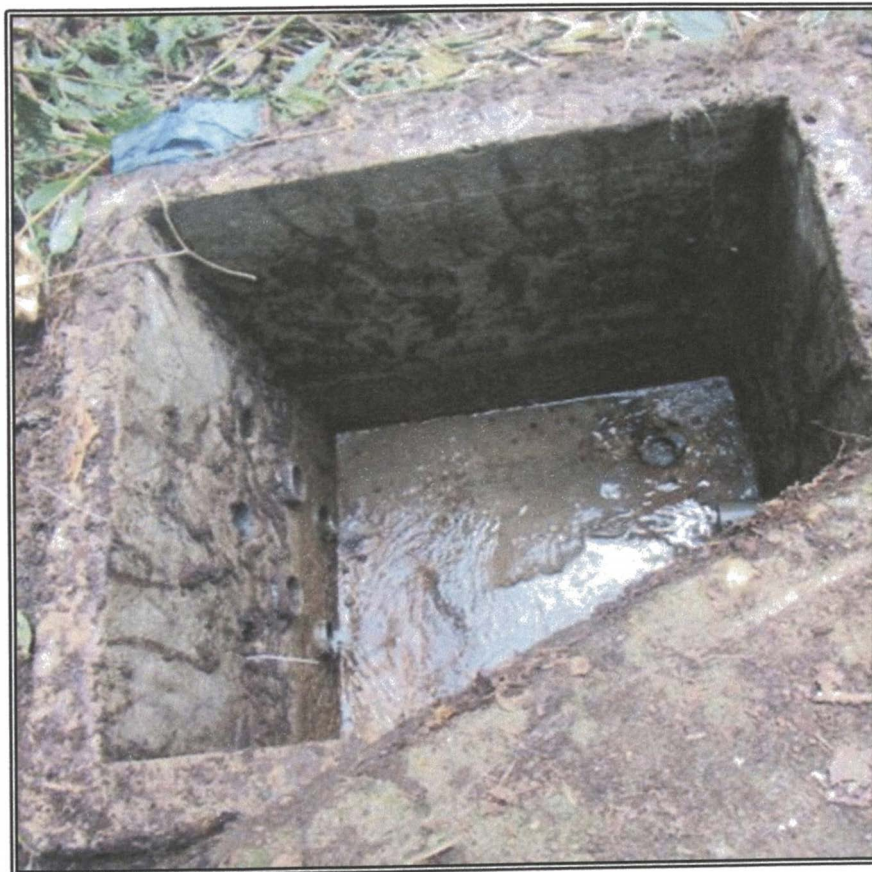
RESERVORIO ELEVADO EXISTENTE DE INSTALACIÓN ARTESANAL (SISTEMA NUEVO MUNDO)
